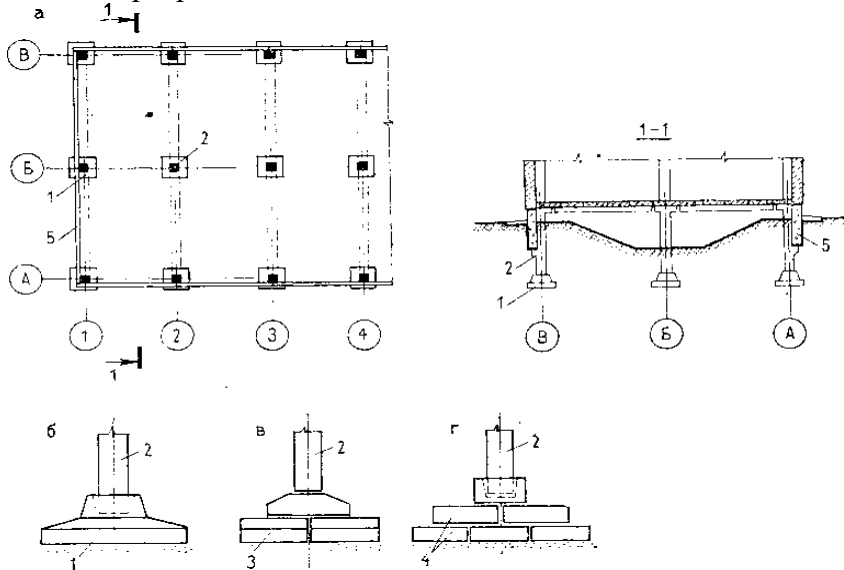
Стовпчасті фундаменти: а - фрагмент плану стовпчастих фундаментів; б - фундаментний блок стаканного типу; в - залізобетонні блоки стрічкових фундаментів; г- блок-стакан та залізобетонні плити: 1 - блок-стакан; 2 - колона; 3 - залізобетонна фундаментна подушка; 4 - залізобетонна плита; 5 - цокольна панель
